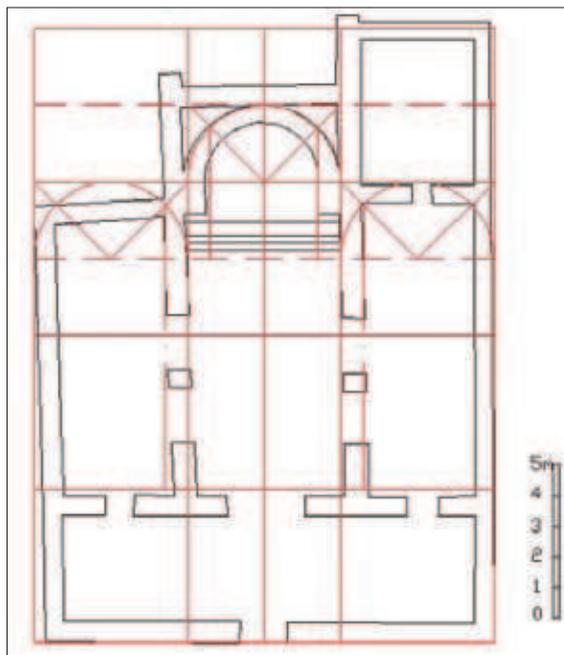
Santa Croce Camerina, Basilica della Pirrera. Pianta: lettura progettuale
